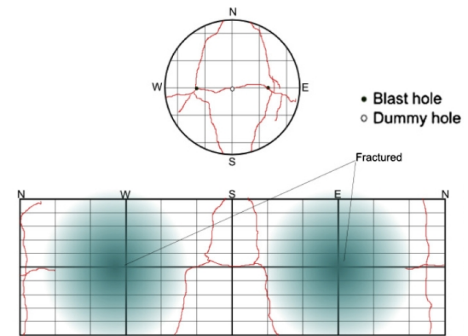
Case-2の爆破後ひび割れ状況³⁾
